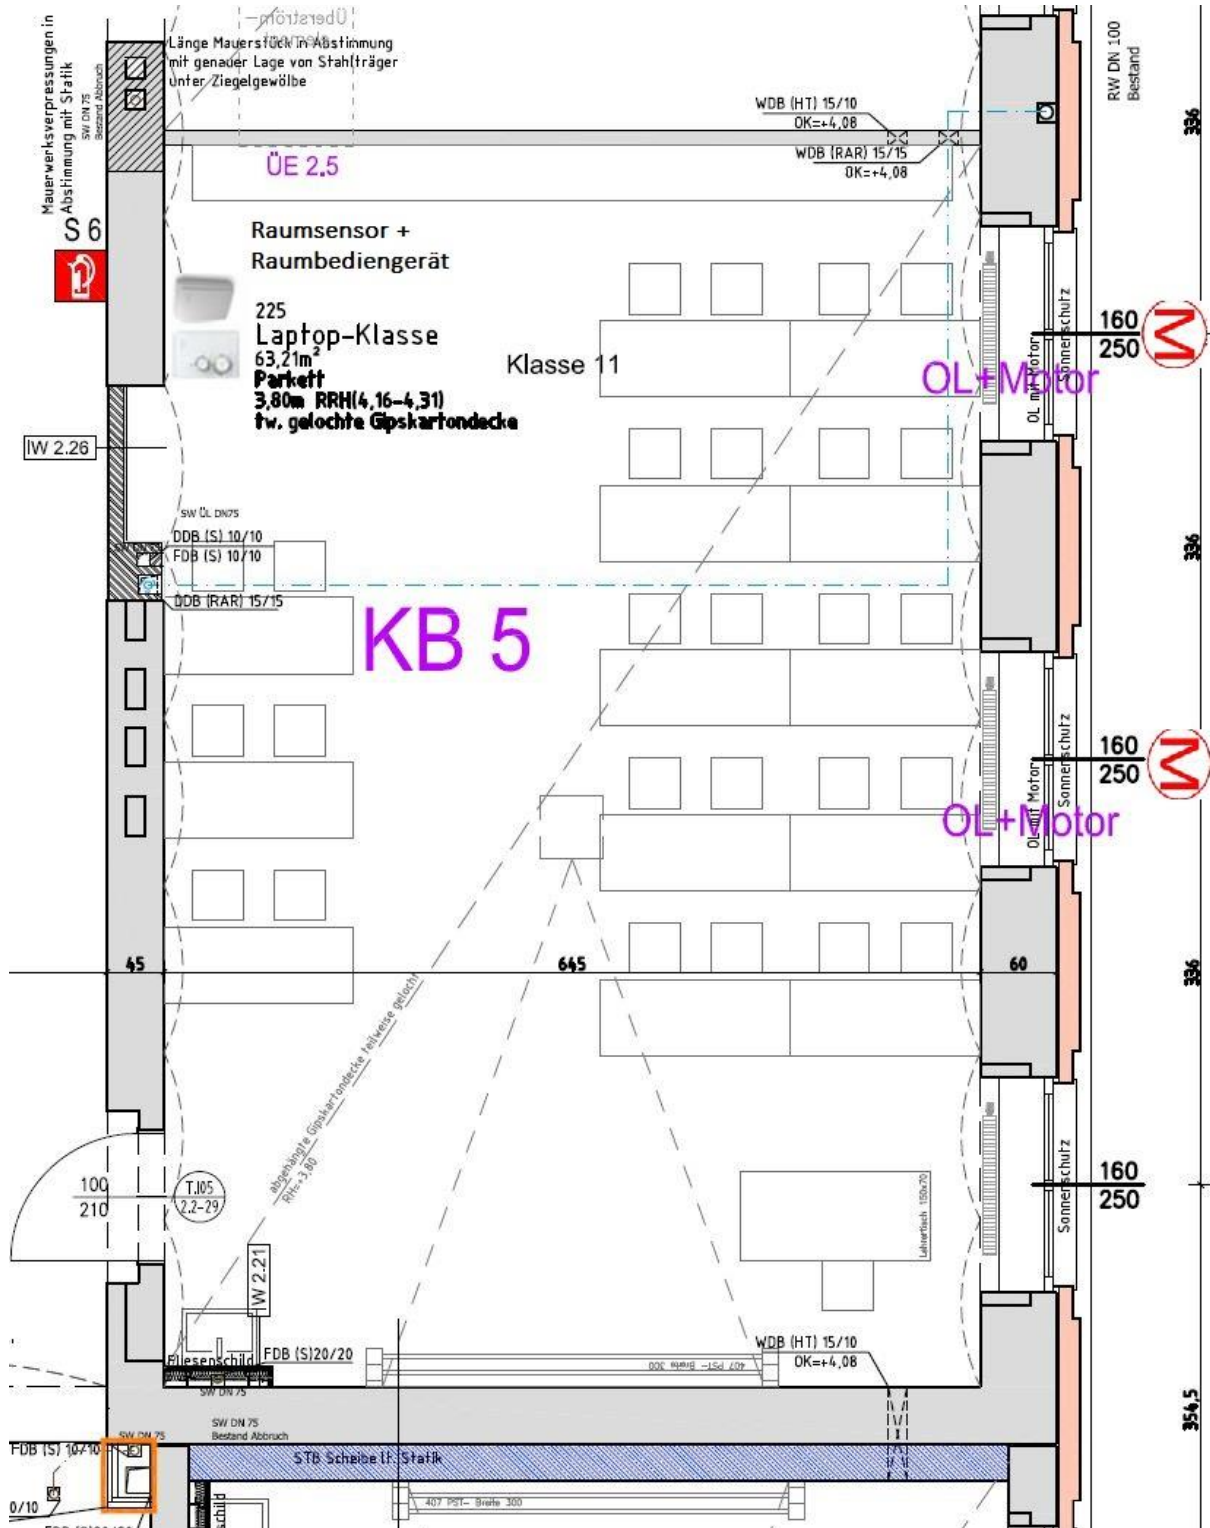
Grundrissplanausschnitt des Klassenzimmers 02.225 (Klassenbest, 2024)
